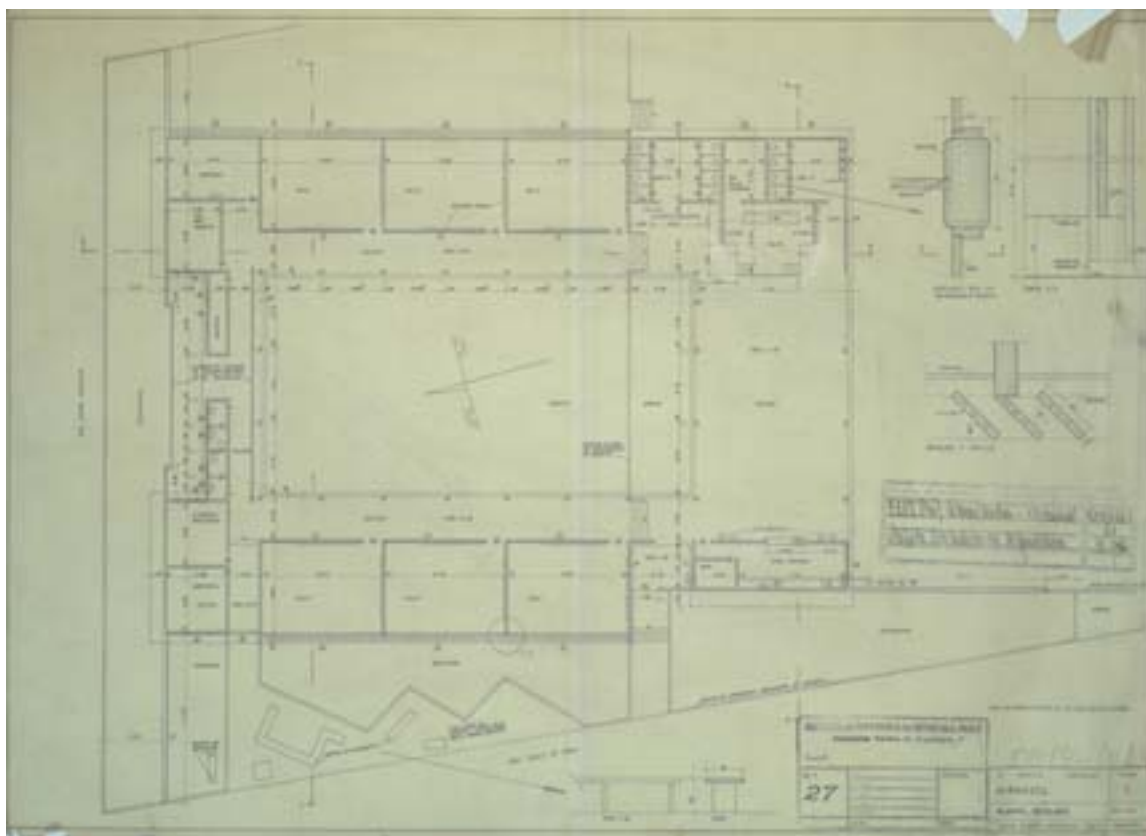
Carlos A. C. Lemos, Grupo Escolar, Mirassol: planta baixa e detalhes
